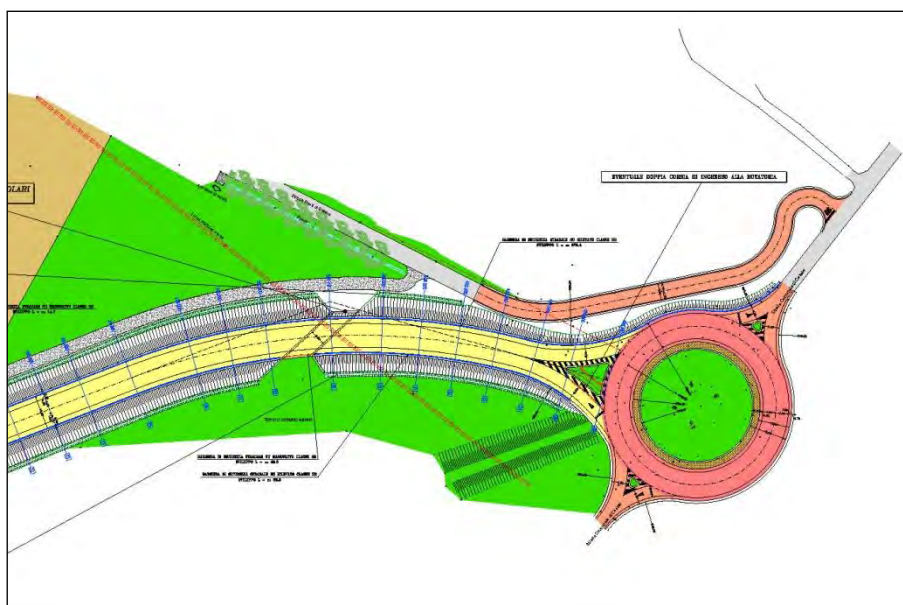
Ingrandimento planimetria di progetto variante giugno 2008: vista nord
